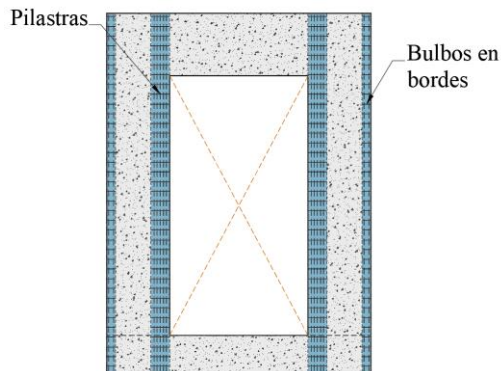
Definición de pilastras y bulbos en muros Tilt-Up
